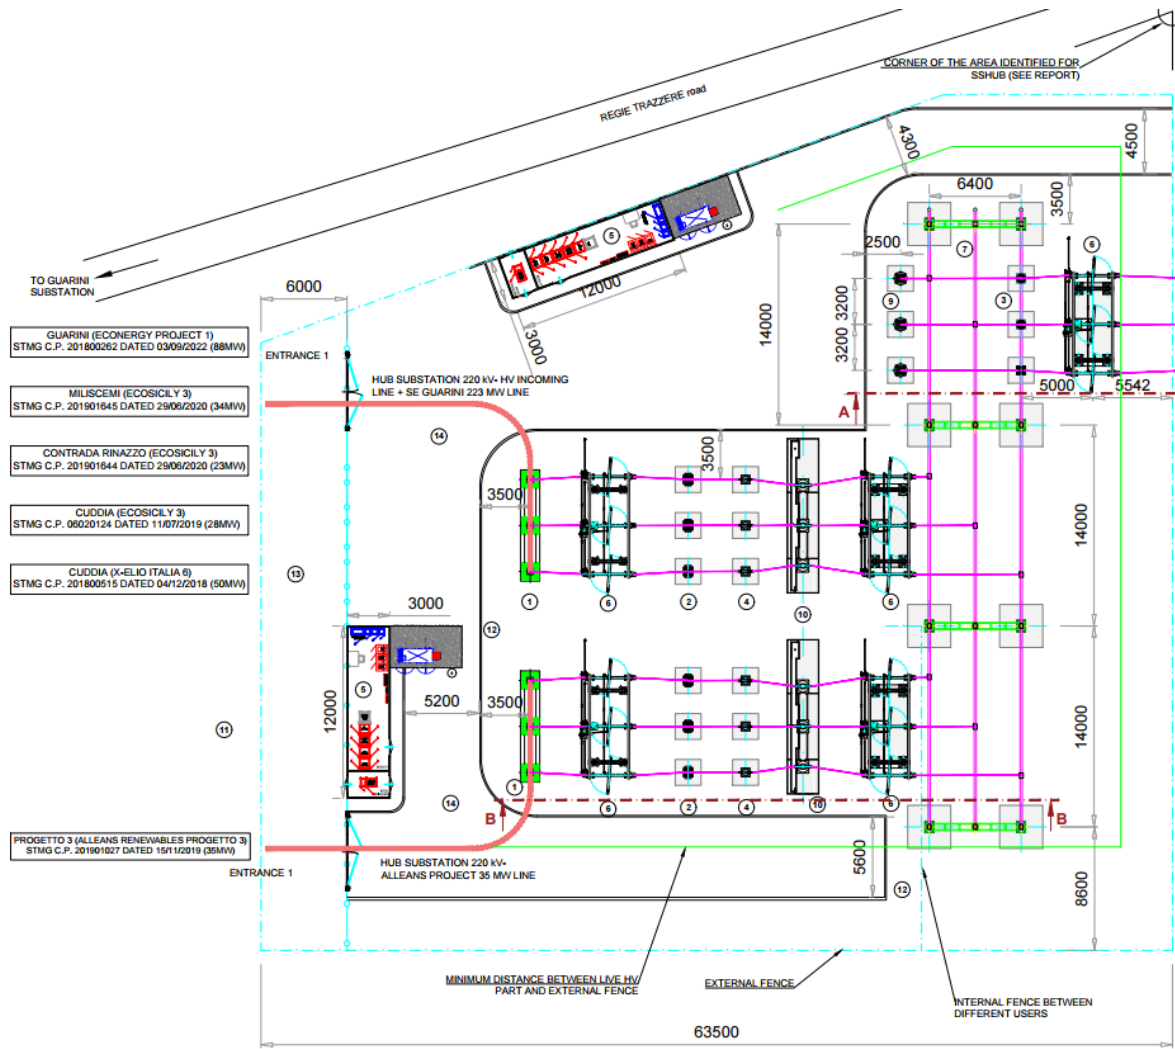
Planimetria apparecchiature elettromeccaniche SS Hub
